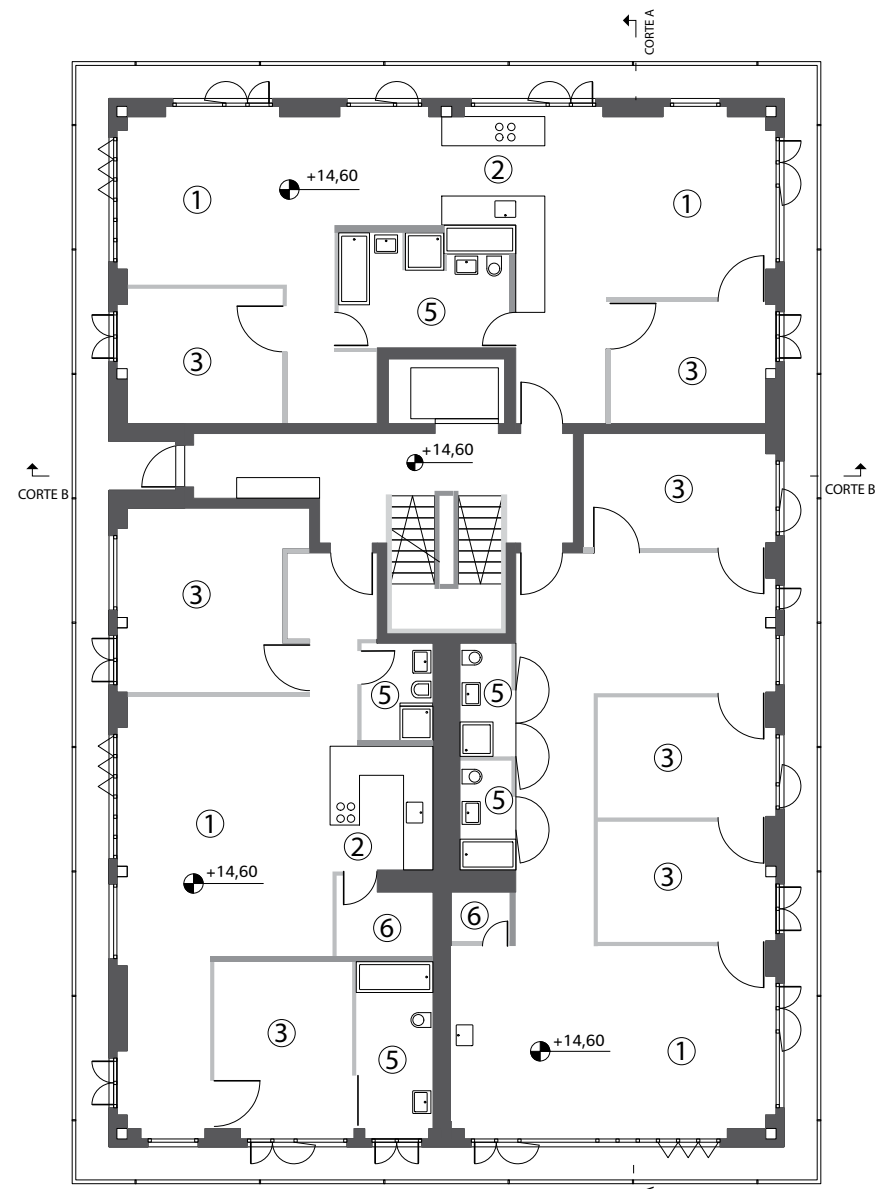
e 91: Plantas baixas segundo e terceiro pavimento.
